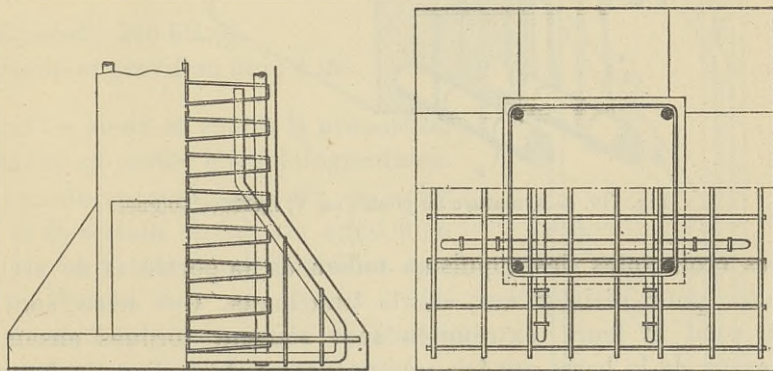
Semelle de fondation et poteau, système Coignet.
